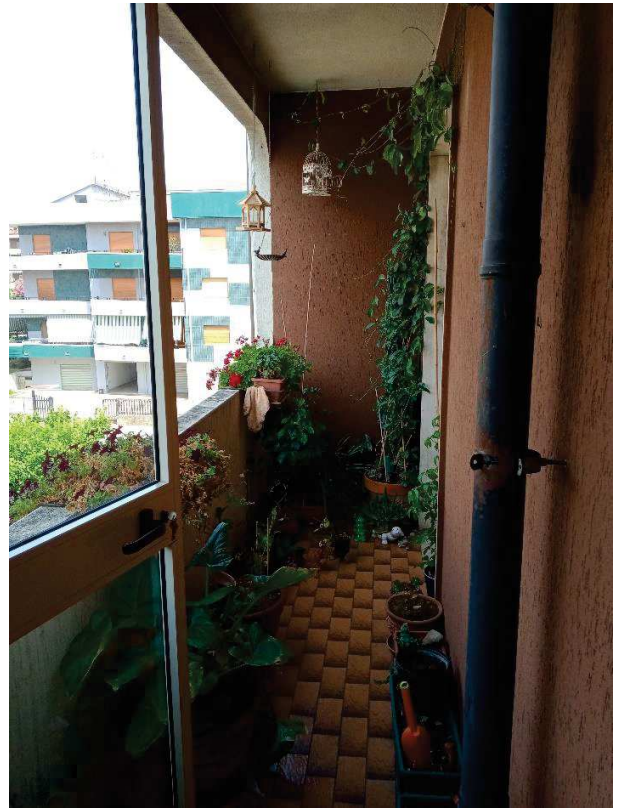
Particolari del terrazzo in parte chiuso.
